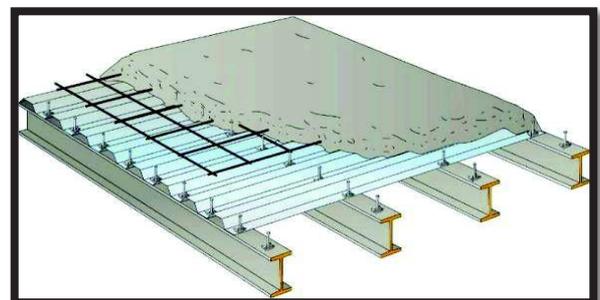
détail d'un assemblage poteau –poutre planché parois.
